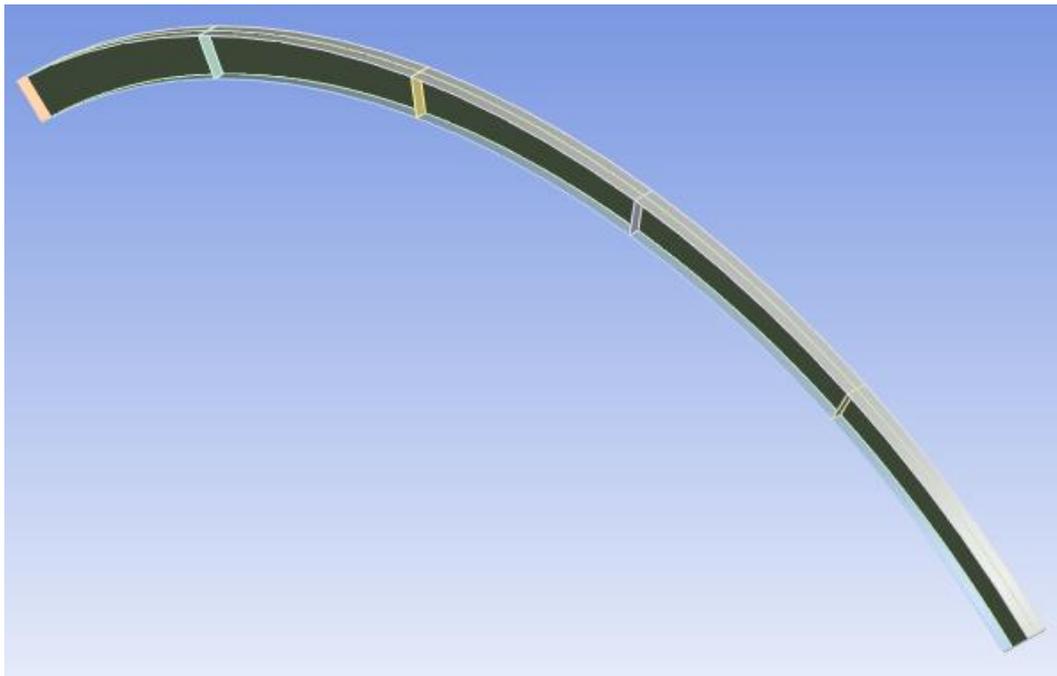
Arco circular de sección 'I' con alma plana y 6 rigidizadores transversales.
